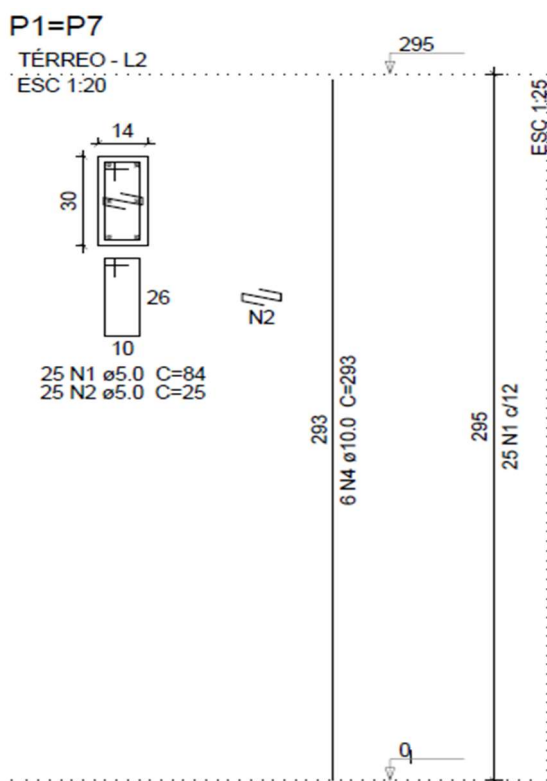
Seção de aço dos pilares e detalhes da armadura long/trans.
